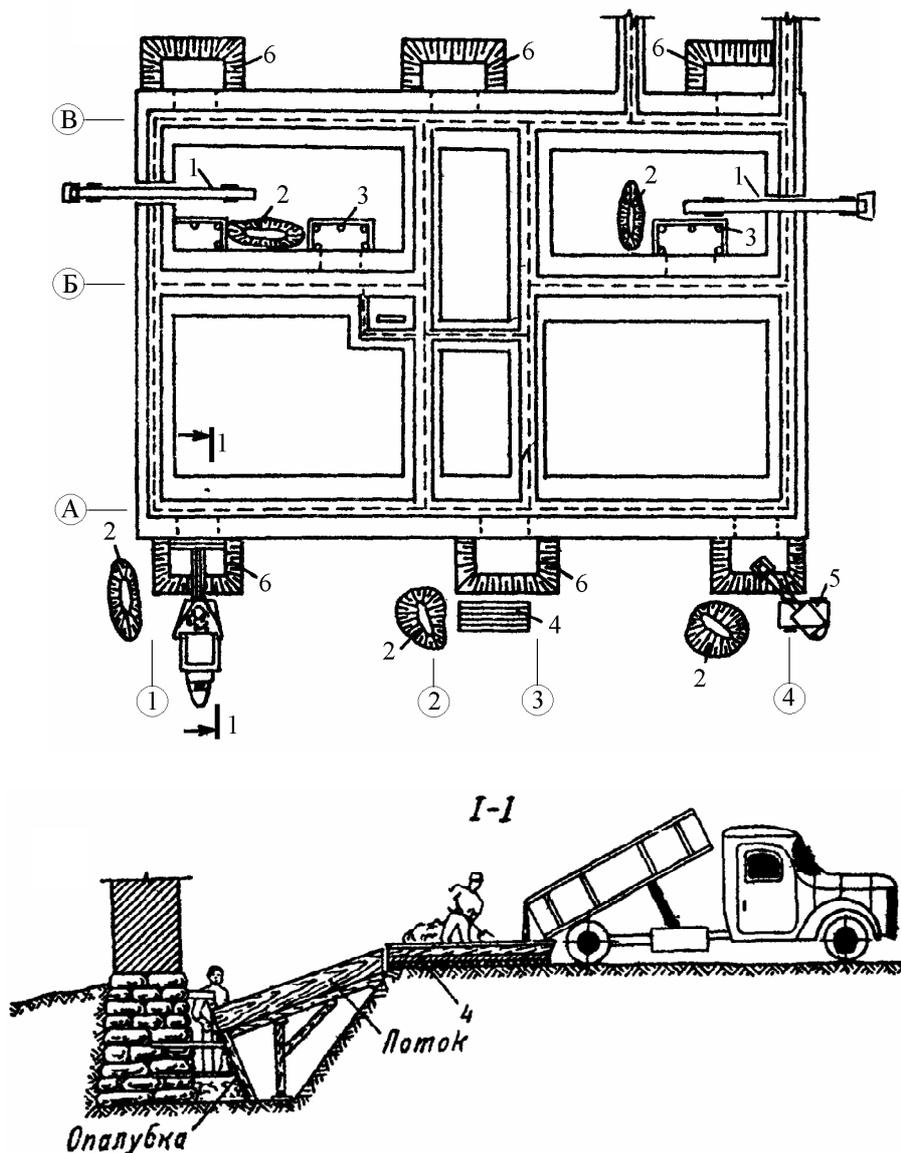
Общая схема организации работ по усилению бутовых ленточных фундаментов с увеличением площади подошвы:
